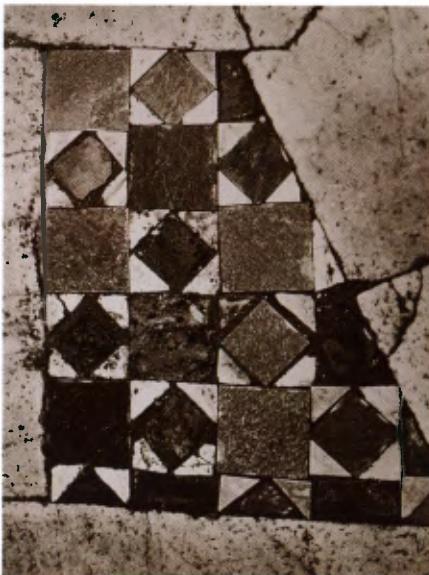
Rotonde. Pavement en *opus sectile* après intervention.
